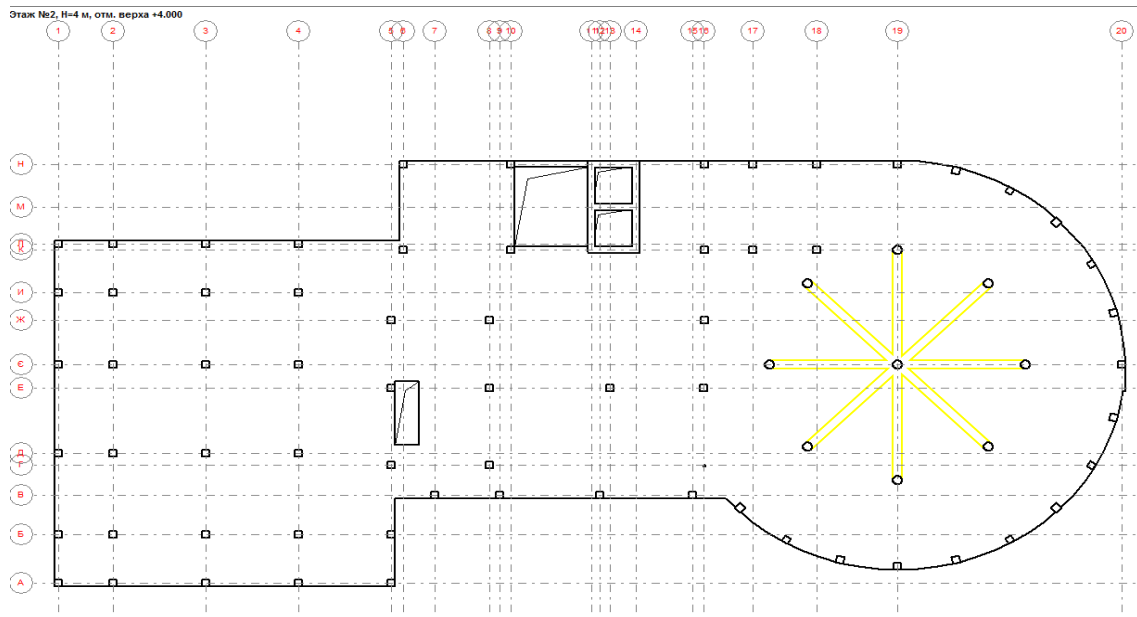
Опалубкове креслення моноліт плити перекриття першого поверху
